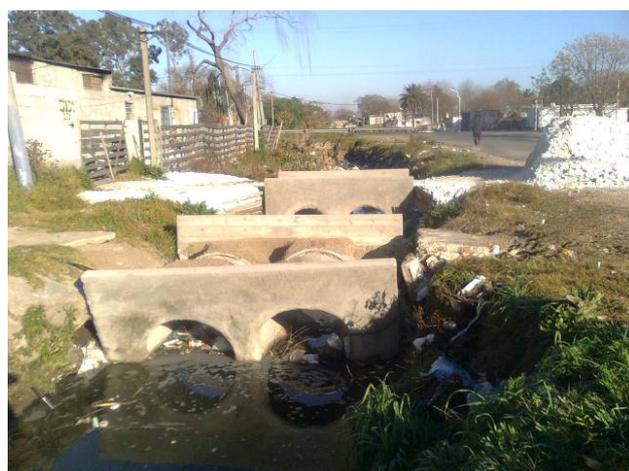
Entradas sobre la calle Matilde Pacheco
